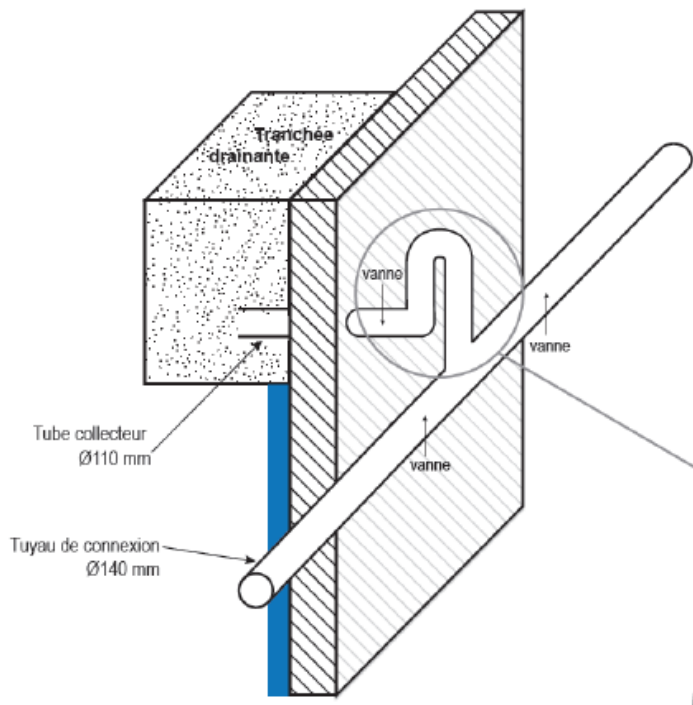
Coupe schématique de la tranchée drainante et du géotextile composite drainant
